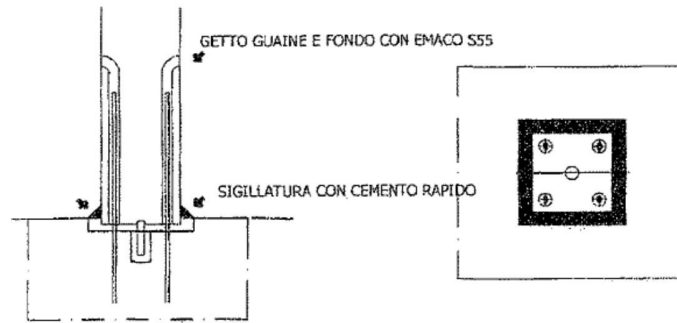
Sigillatura perimetrale del fondo dei pilastri
